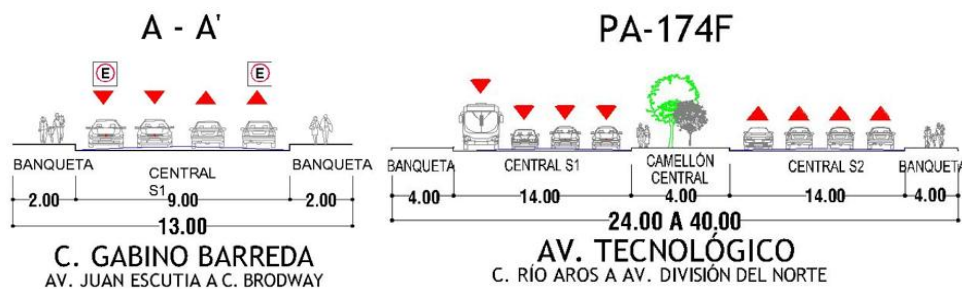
Sección vial actual. Fuente PDU 2040 vigente.
